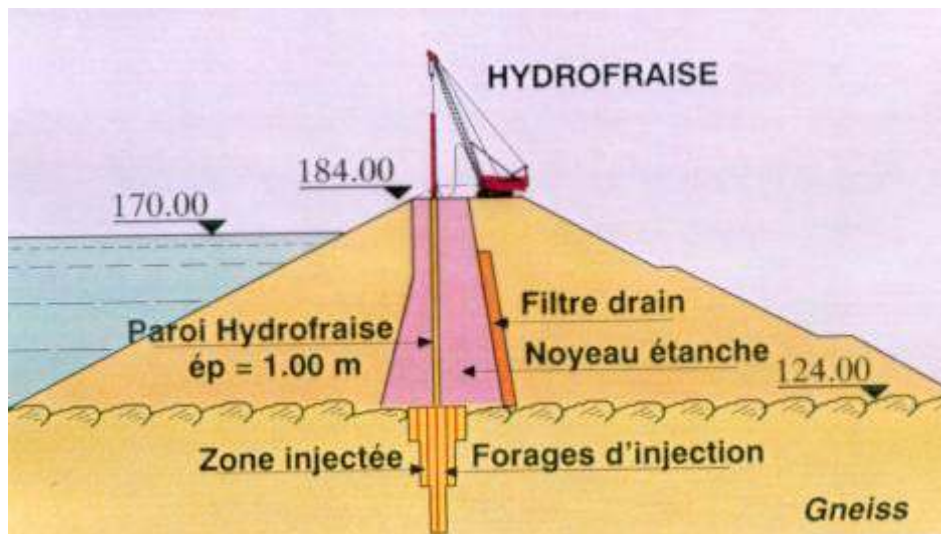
Barrage sur l'Agly - France – 1991 – Coupe transversale
